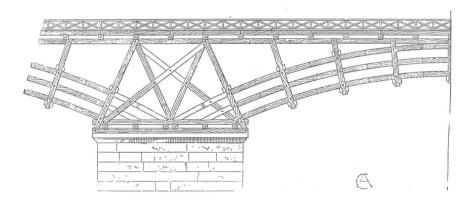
Detalle de la estructura del puente del Danubio. Las piezas rayadas son las que aparecen en el bajorrelieve; las piezas a línea son añadido del autor
